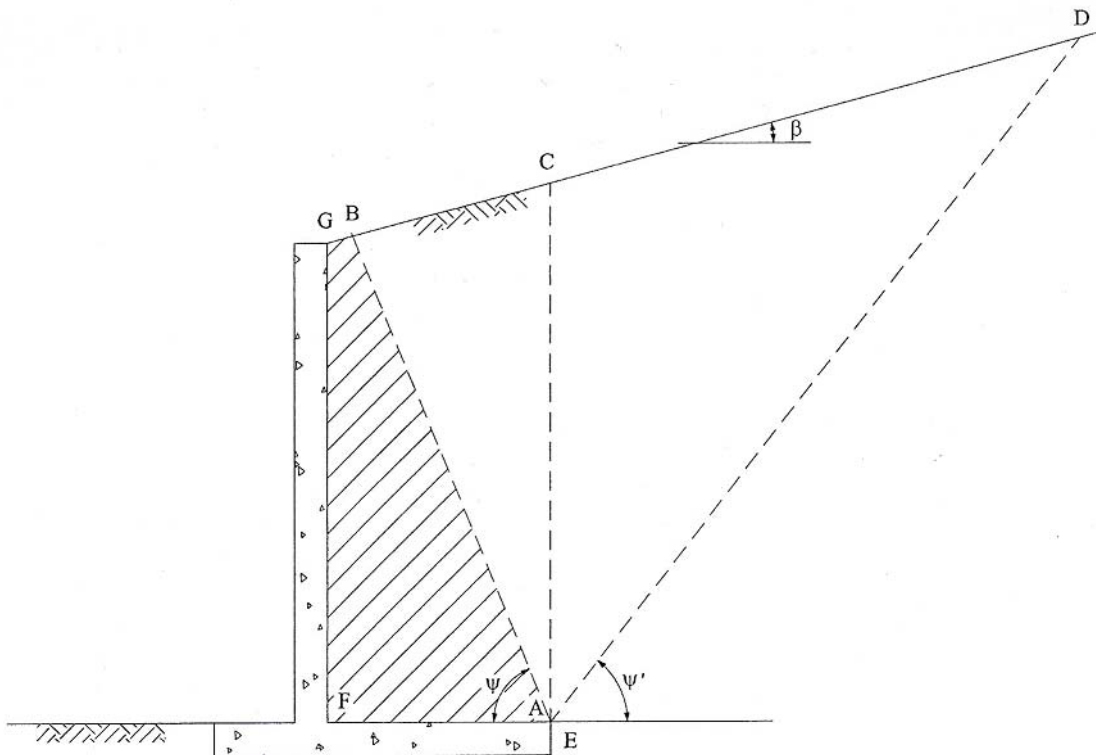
Muro de betão armado e cunhas de terras em estado limite activo no maciço suportado
